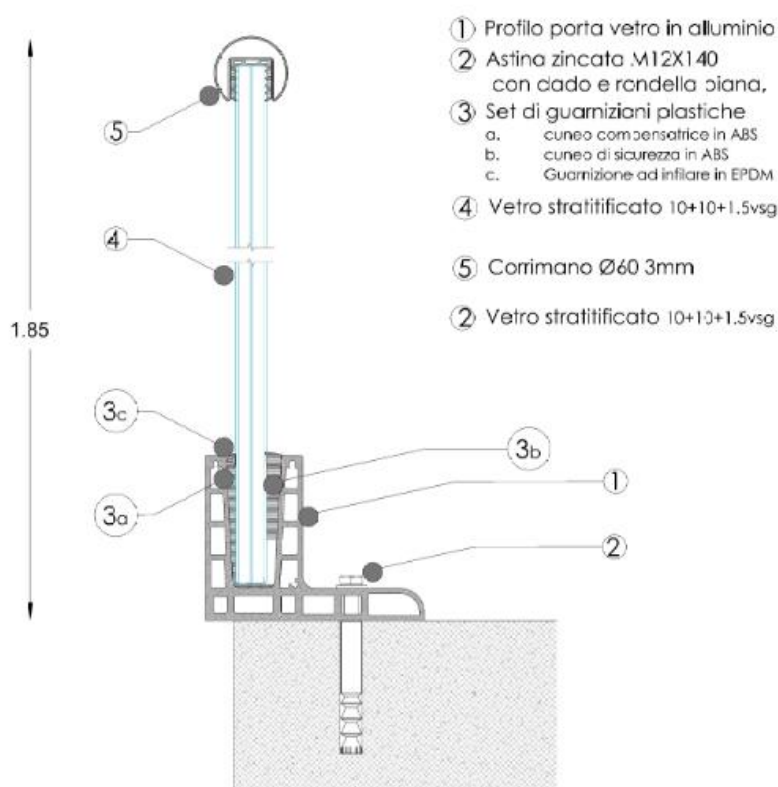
Particolare chiusura di protezione frontale Led Wall.
